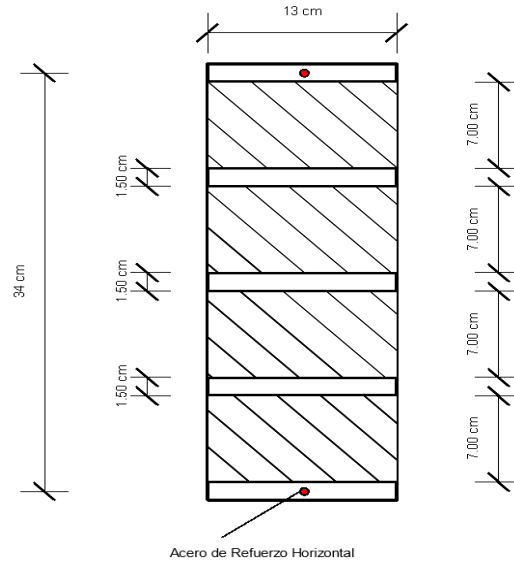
Vista Frontal - Detalle Acero Horizontal del Muro de confinamiento.
